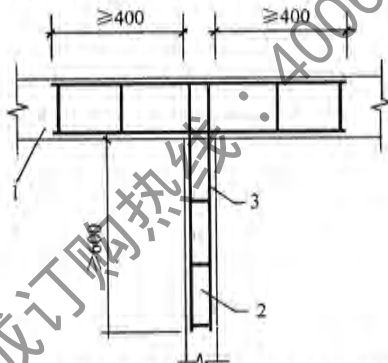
砌块墙体与后砌隔墙交接处钢筋网片
